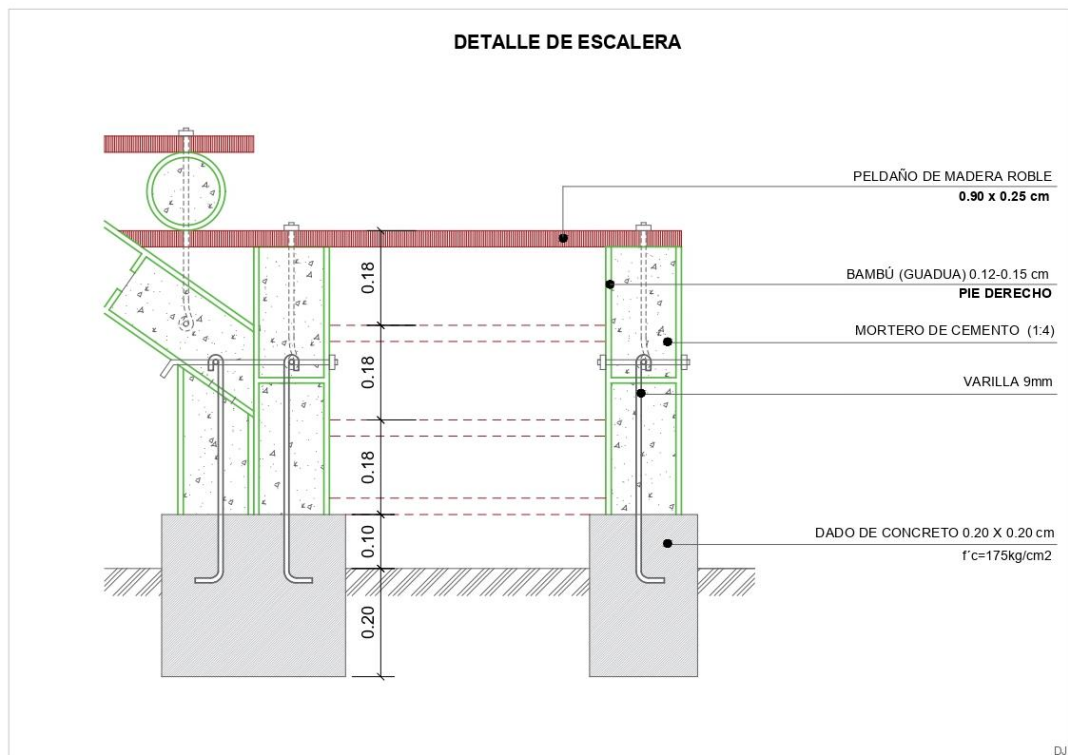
Detalles constructivos de escalera. Fuente: El autor
